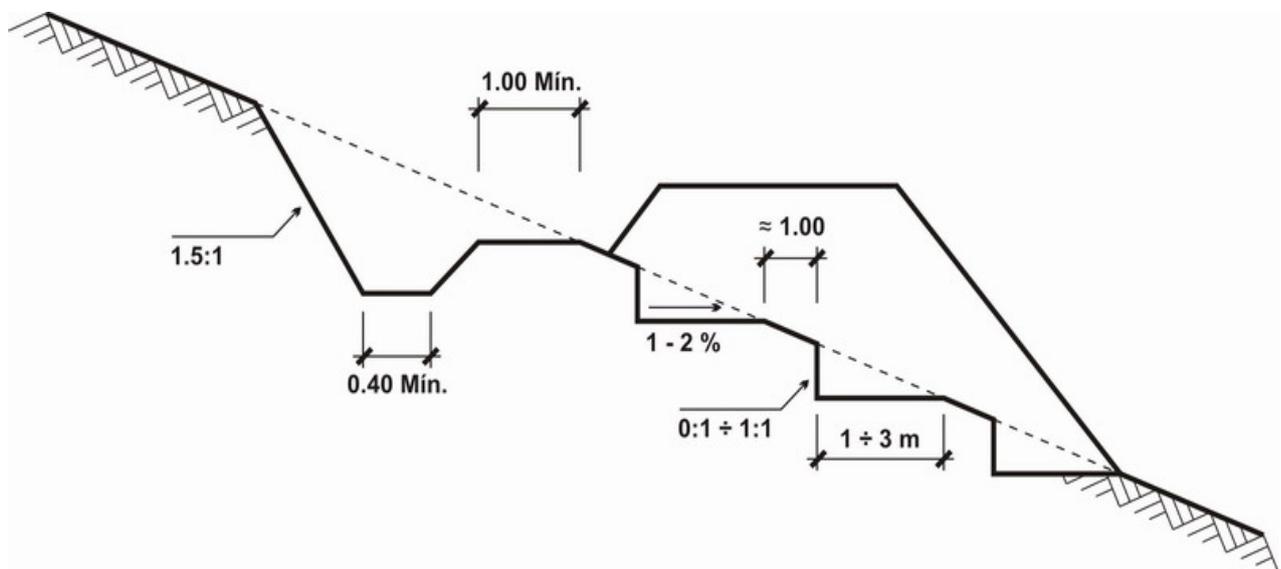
Sección transversal típica de terraplén hasta 12 m de altura, para pendientes transversales del terreno mayor del 30 %
